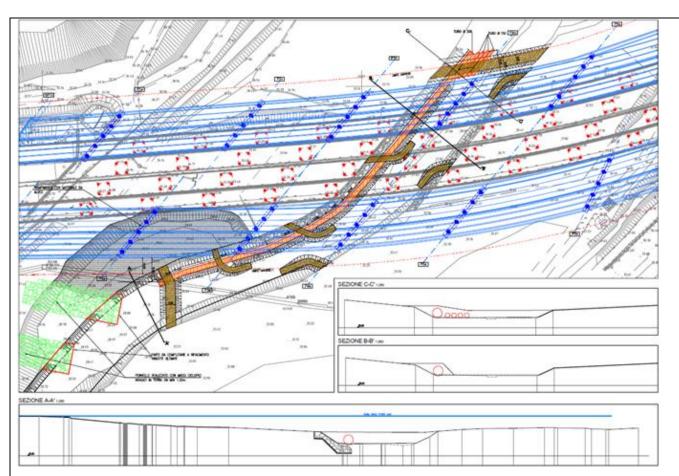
Ipotesi di sistemazione dell'alveo del fiume Reno in fase di cantiere
